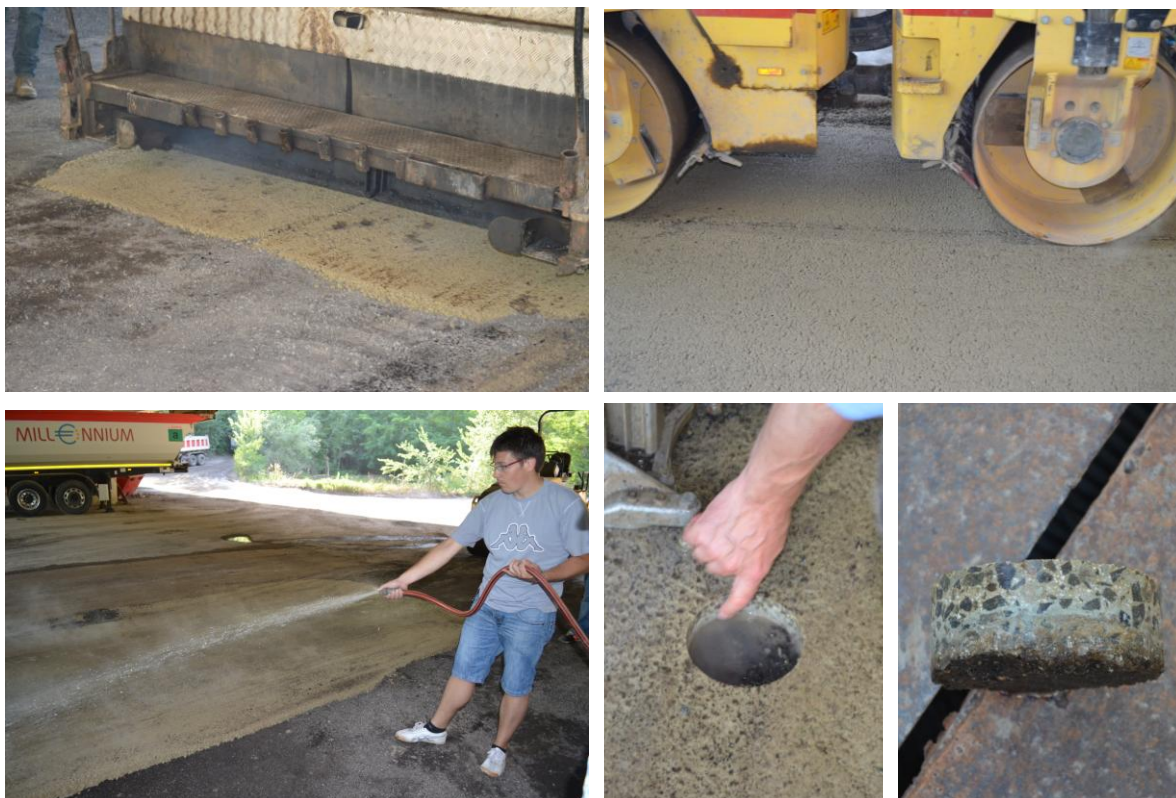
Stesa di prova nel piazzale dell’Impianto Bitumisarco
